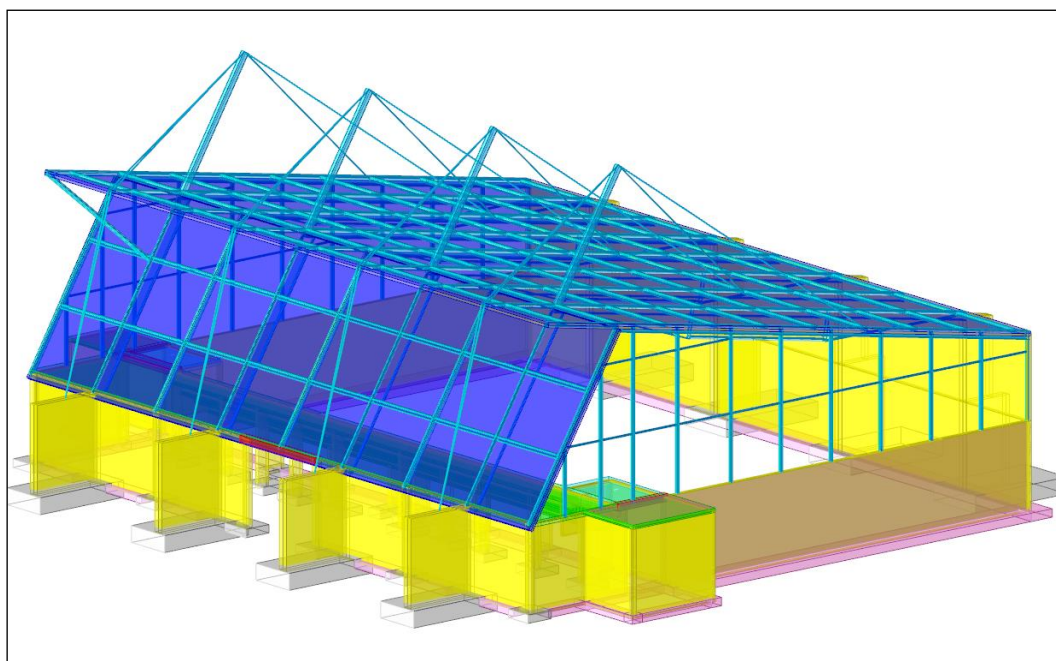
vista del modello FEM (caratteristiche geometriche)
